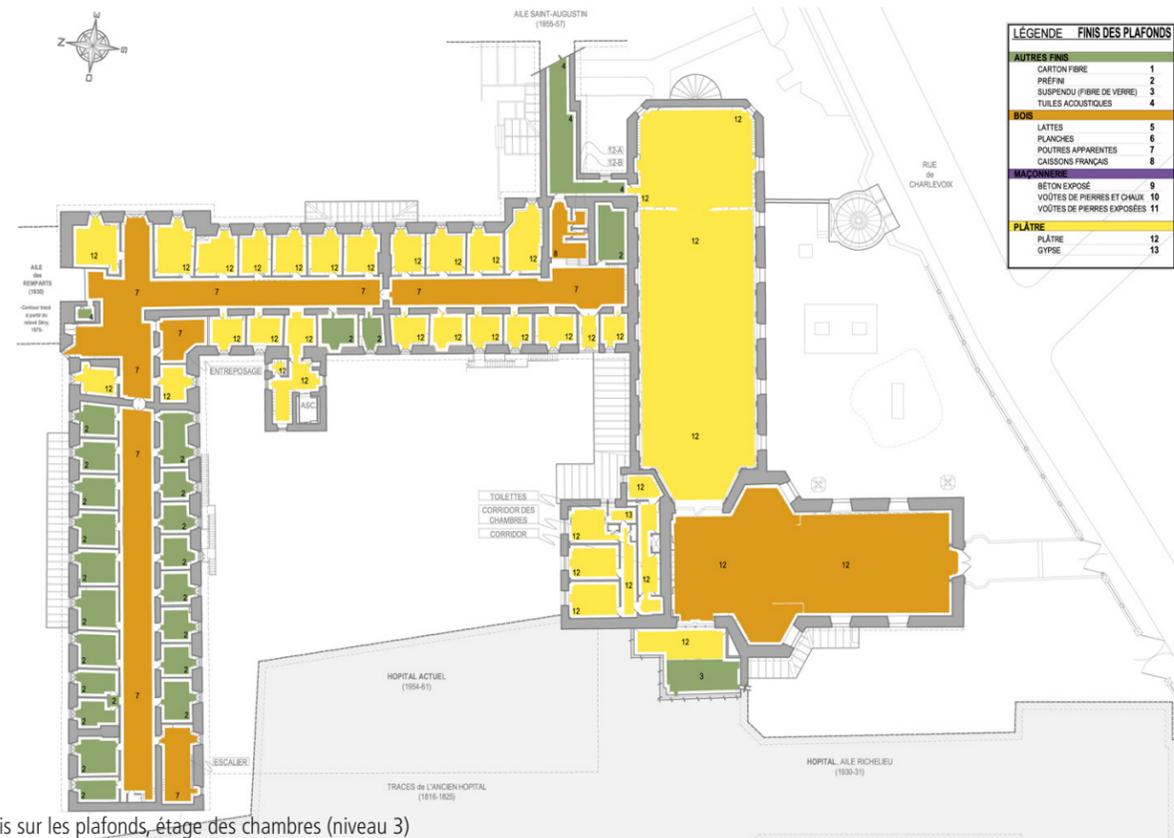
Plan des finis sur les plafonds, étage des chambres (niveau 3)
